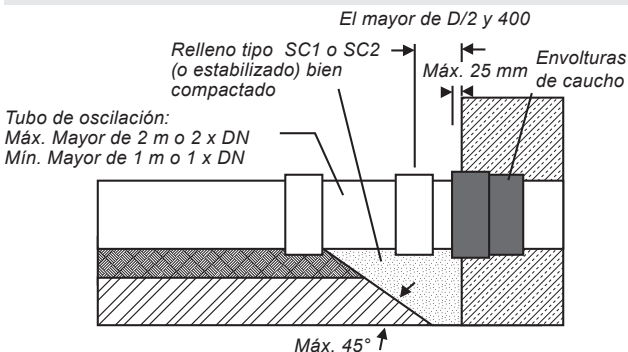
Conexión alternativa – Revestimiento de caucho hormigonado
